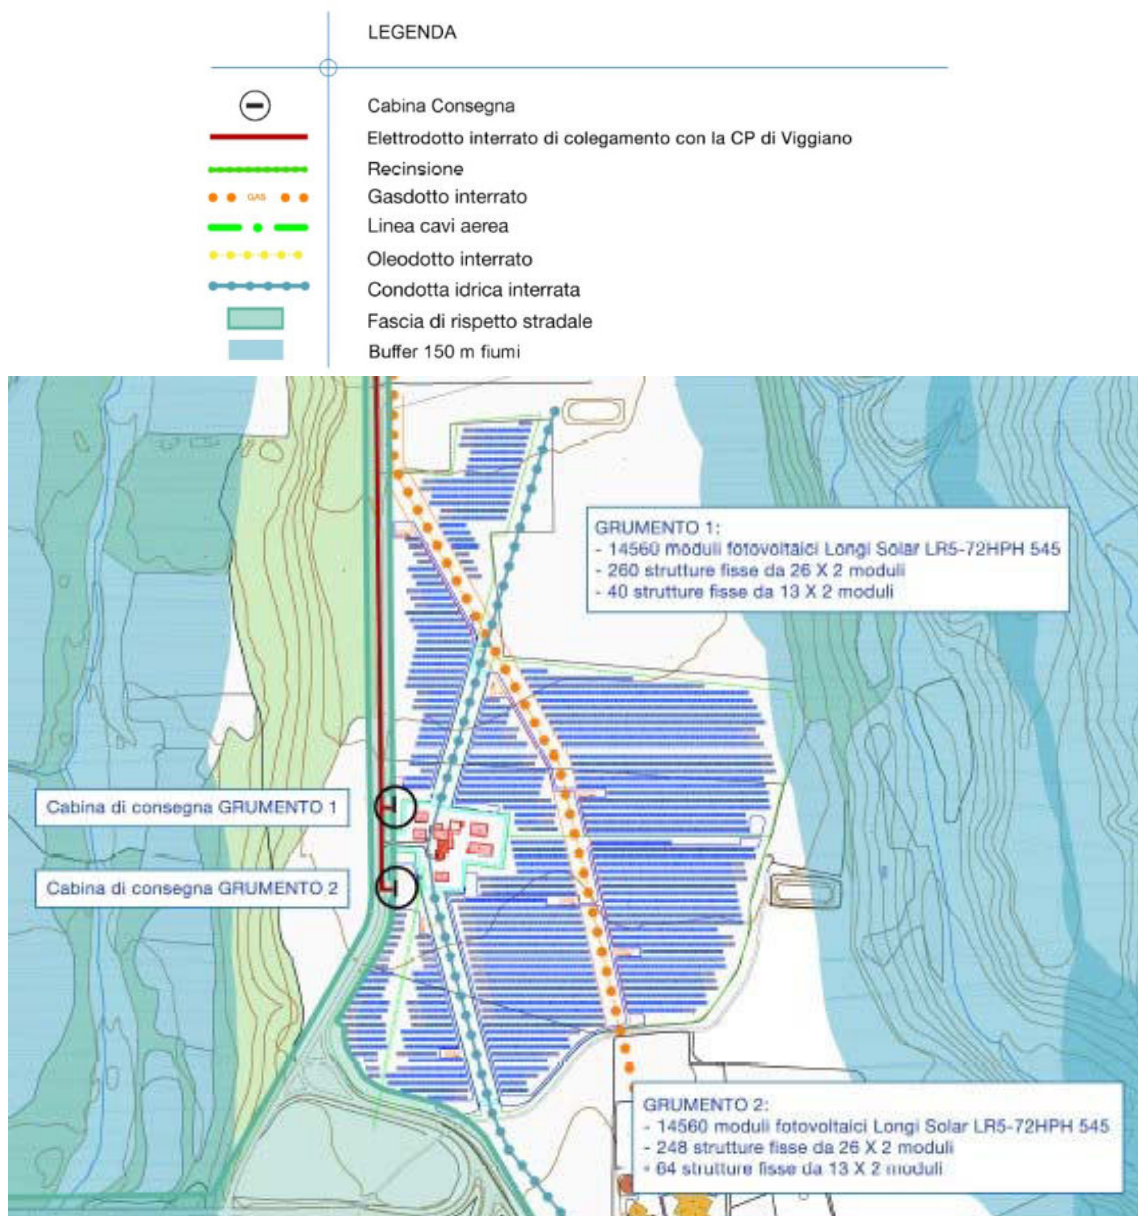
Layout dell'area di Impianto con indicate le interferenze
